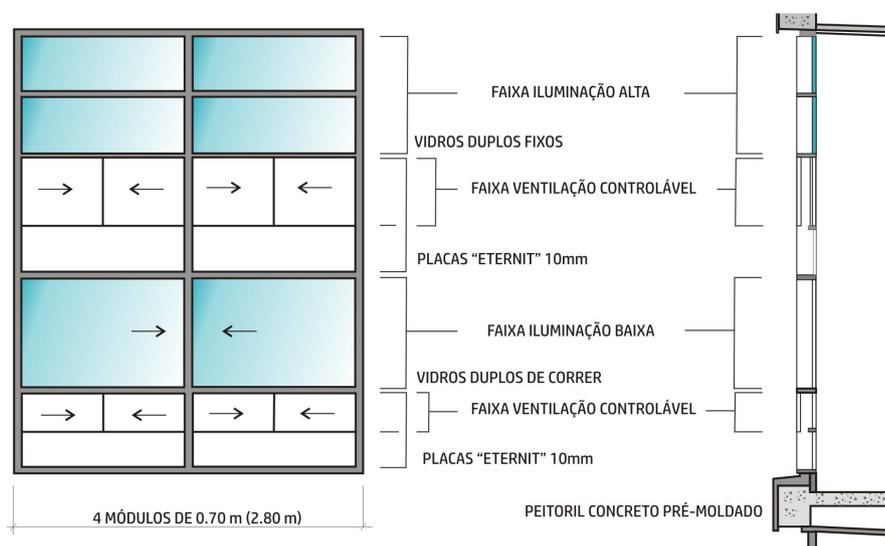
Vista frontal interna e seção do painel M1, com especificação de materiais. Fonte: AUTOR (2018) com base em EESC (1959).
